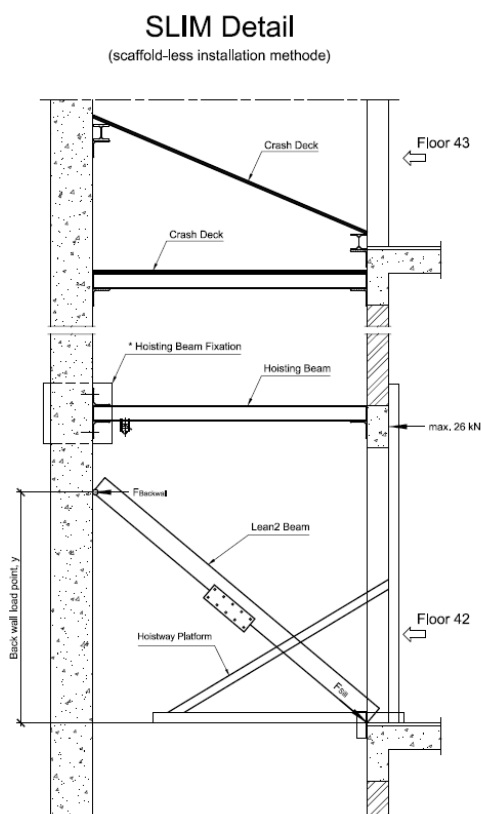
Detalle del Crash Deck para montaje faseado
